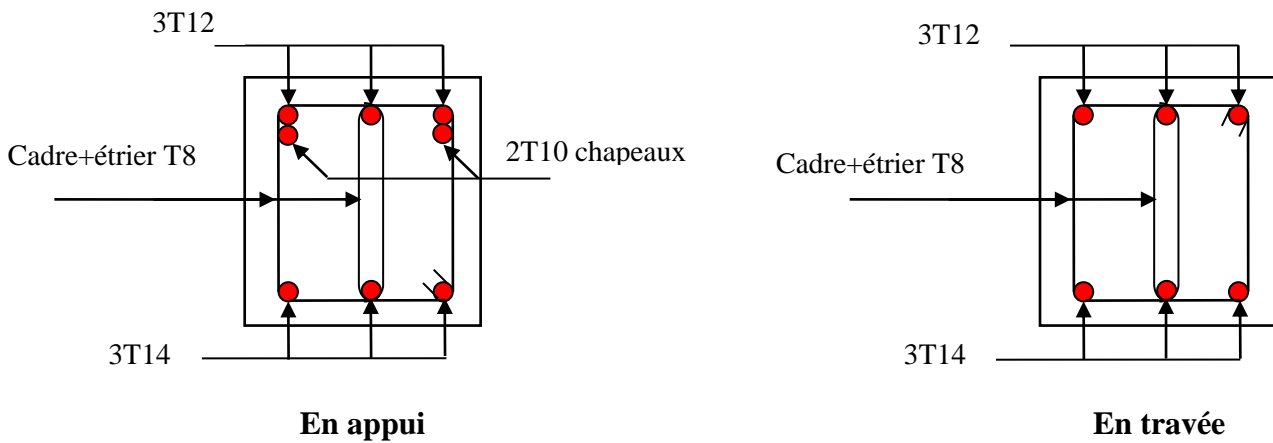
Schémas de ferrailage des poutres principales sous-sol
